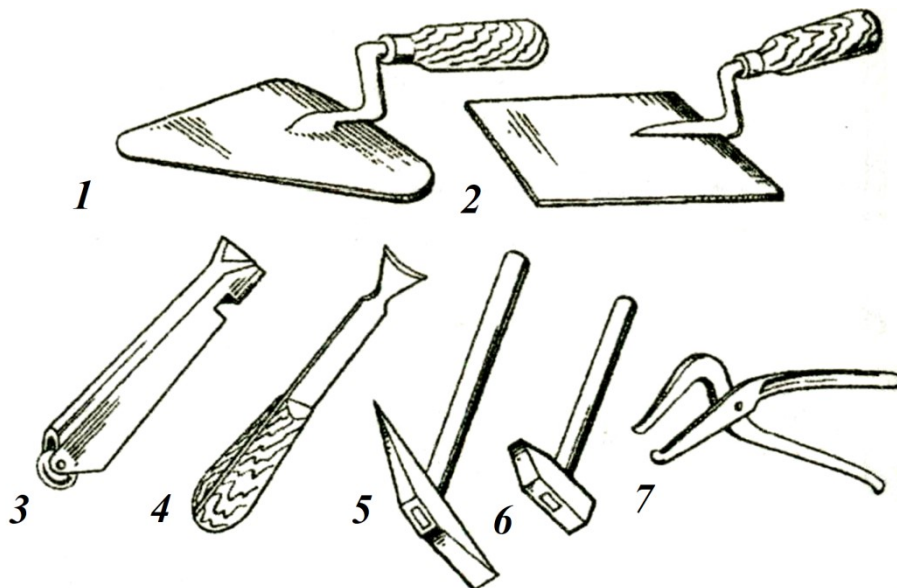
Ручні інструменти для виконання облицювальних робіт: 1- кельма; 2 - лопатка; 3 - різак для керамічних плиток; 4 - те саме, полістиролових; 5 - кирка; 6 - молоток; 7 - кусачки
